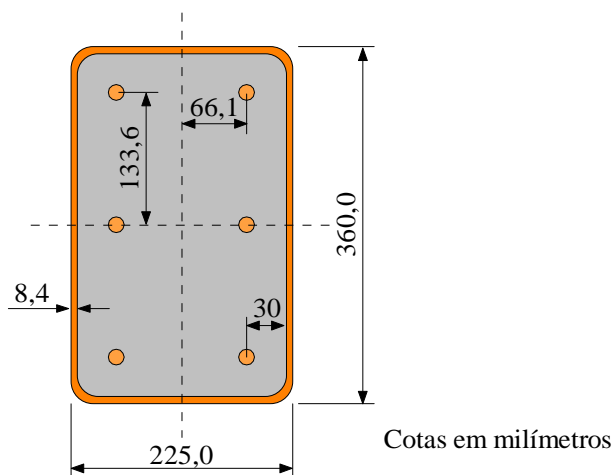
Distribuição da armadura na seção TR 360,0 × 225,0 × 8,4
